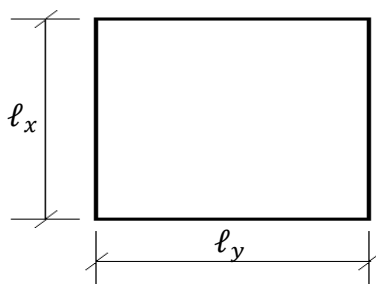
Vãos da laje retangular armada em duas direções.
